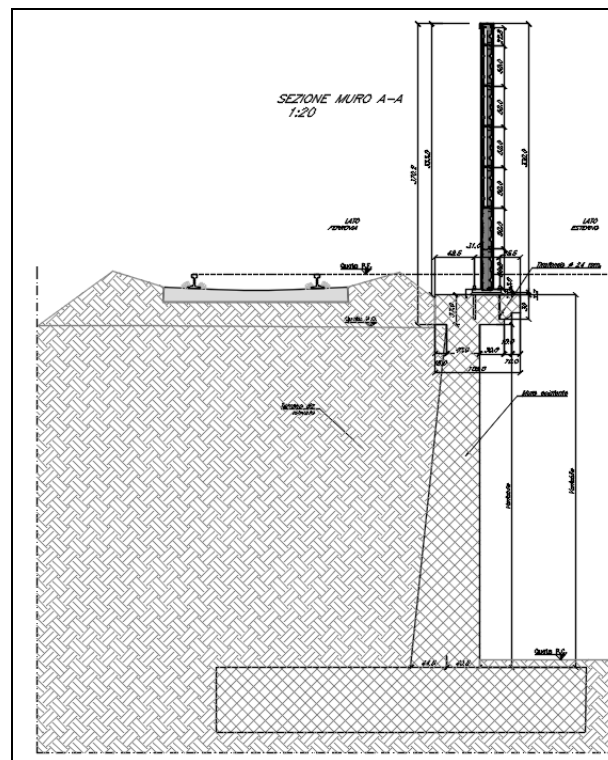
Sezione barriera ML-1 ancorata alla testa del muro esistente
